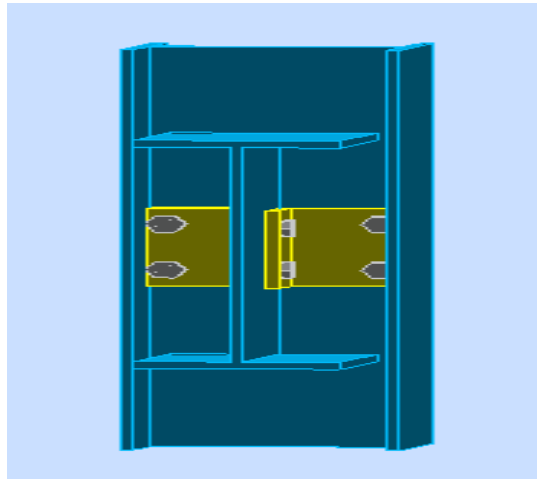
Vue de l'assemblage poteau-poutre maitresse
